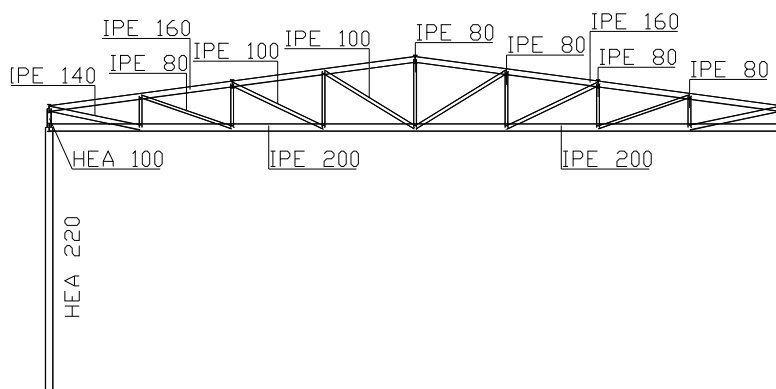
Pórtico com pilar de alma cheia, viga em treliça, vão de 20.00m, pilar em perfil com secção transversal HEA, viga em perfil com secção transversal IPE.
